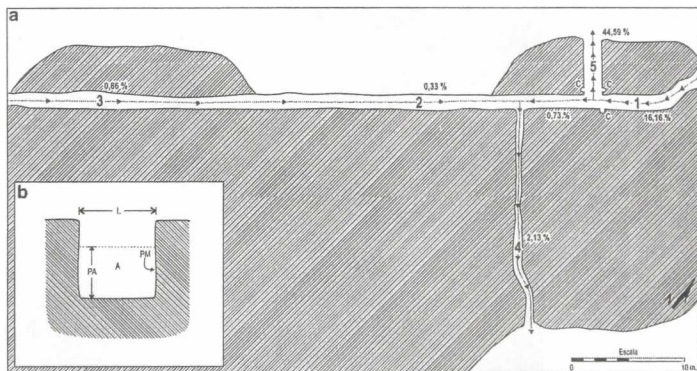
A - Complejo Piedra Raja. Los números 1-5 indican los sectores. Las flechas la pendiente y valor de la misma. B- Sección de canal y sus elementos de valor hidráulico L: Ancho del canal (mts.); PM: Perímetro Mojado (mts.); A: Área (mts.²); PA: Altura o Pelo de Agua (mts.).
